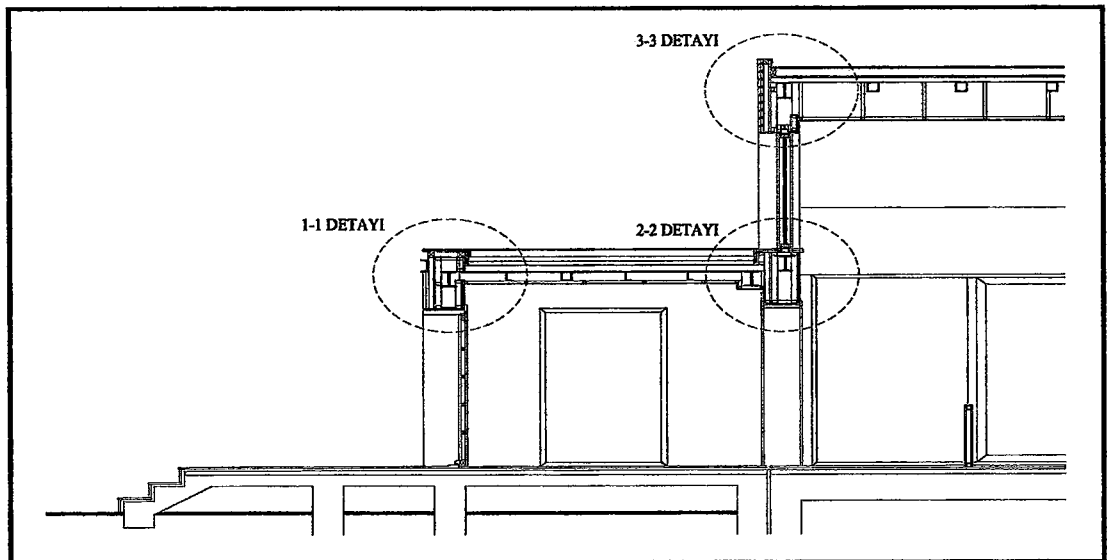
Sistem detaylarının çizildiği aksları gösteren anahtar plan
